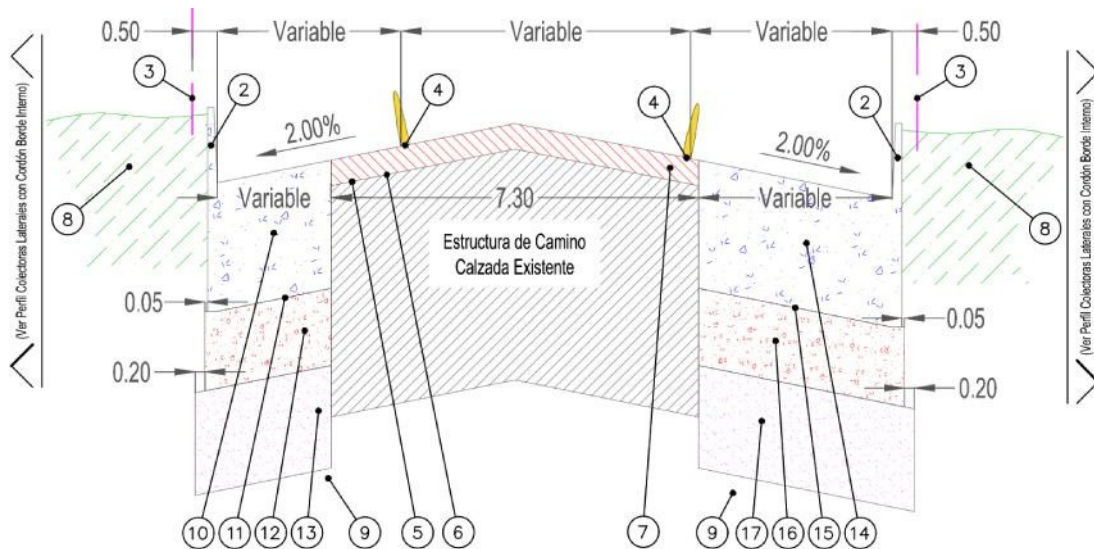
Estructura de Camino Tipo en Canalización ((Doble Calzada)
